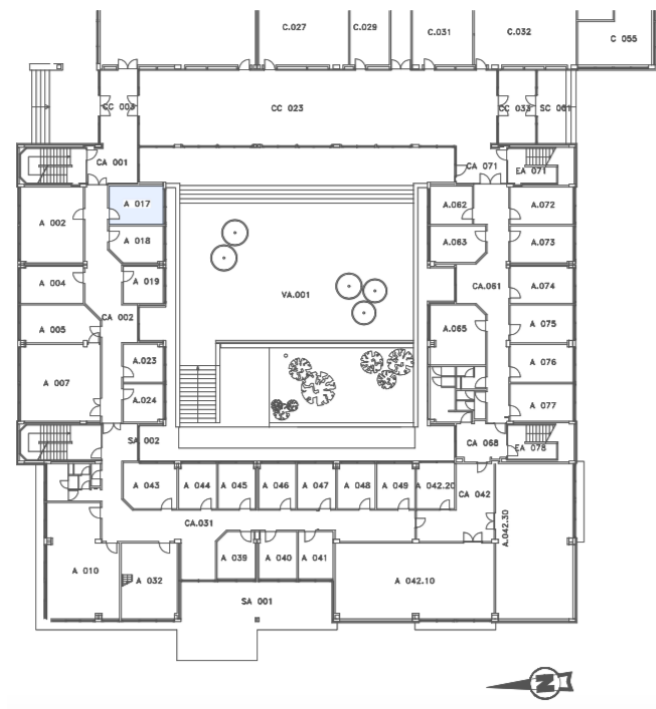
Plan du rez-de-chaussée du bâtiment Vinci
